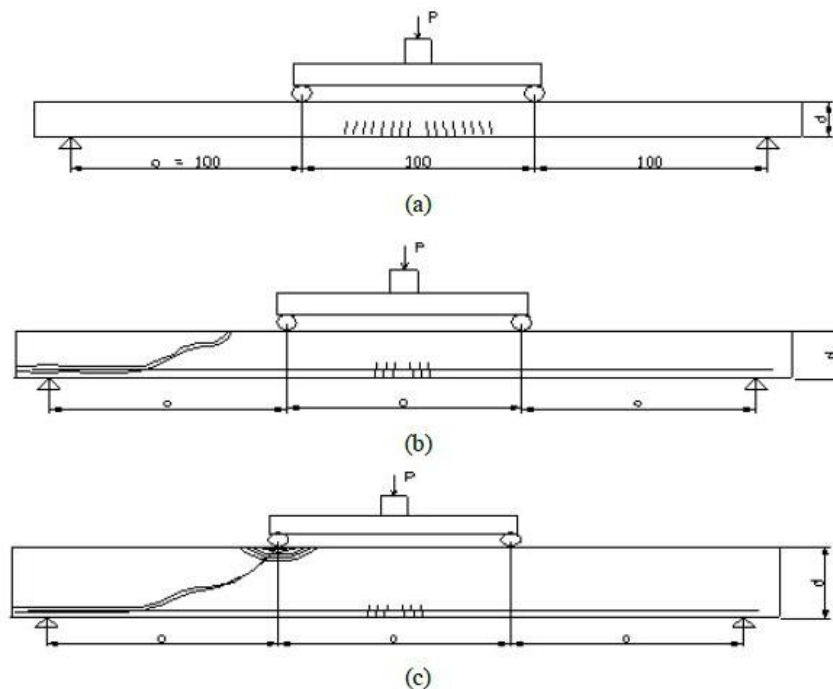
Perilaku Beban-Lendutan Struktur Beton
